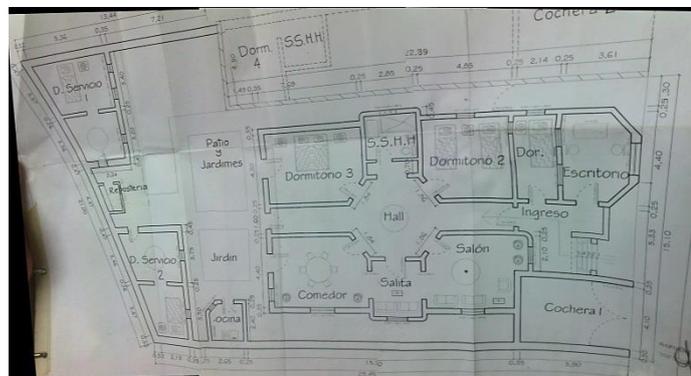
Plan der Villa vor dem Abriss und Neubau des Geschosswohnungsbaus, Quelle: Foto AL, Plan Nafisini S.A.C.
